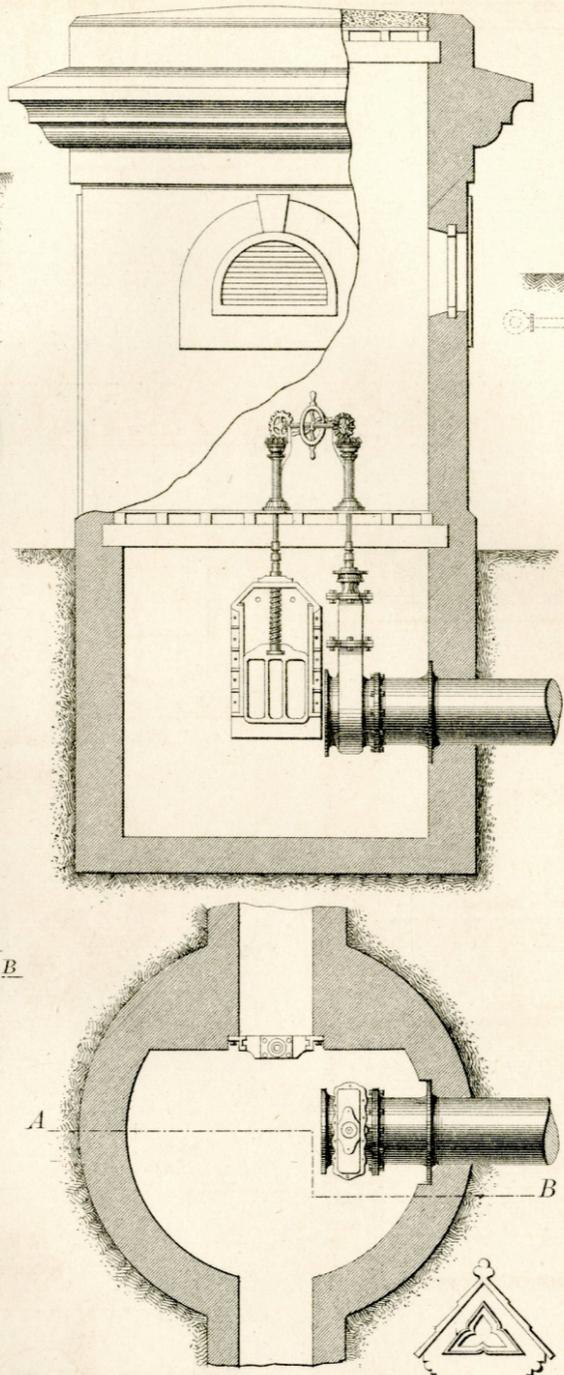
e 7. Pianta, Prospetto e Spaccato del pozzo d'irrigazione. - 1 a 75.
